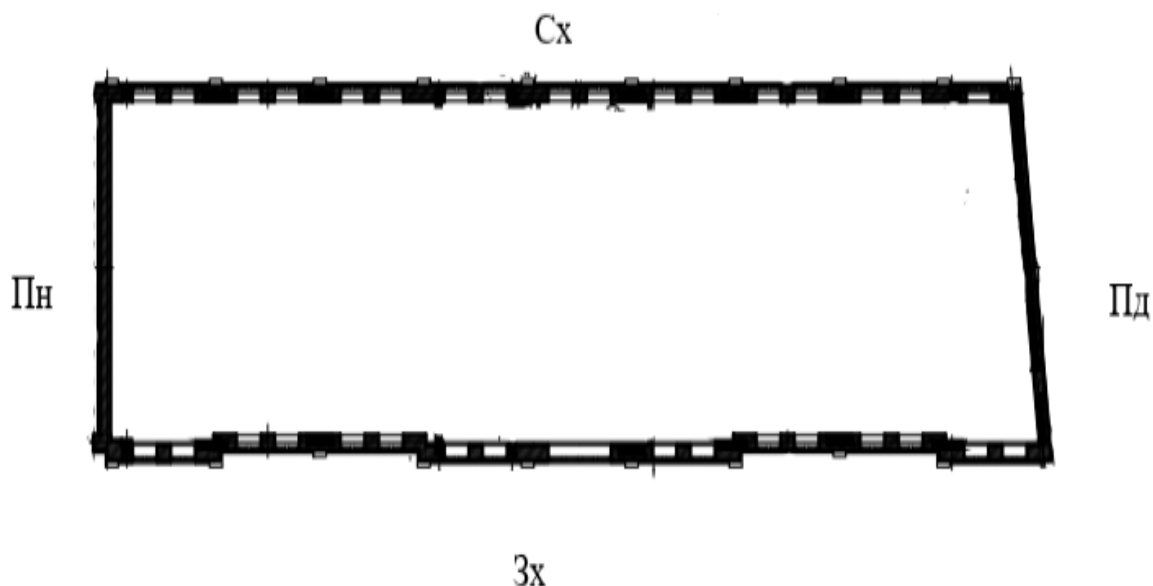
Схематичне зображення плану будівлі, орієнтовану за сторонами світу
